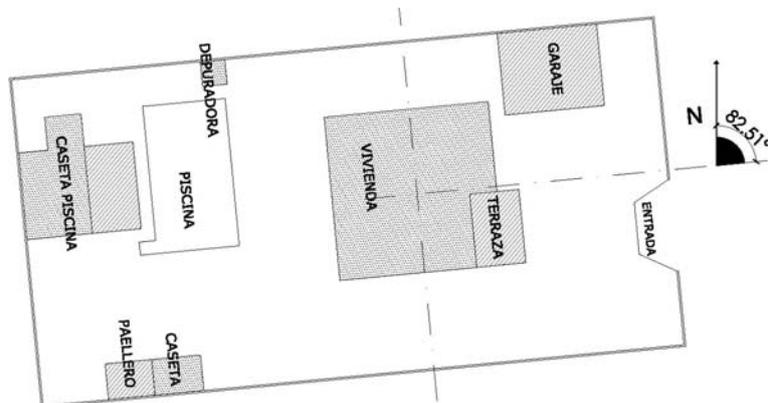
Plano de Distribución de Parcela y orientación de Fachada.
